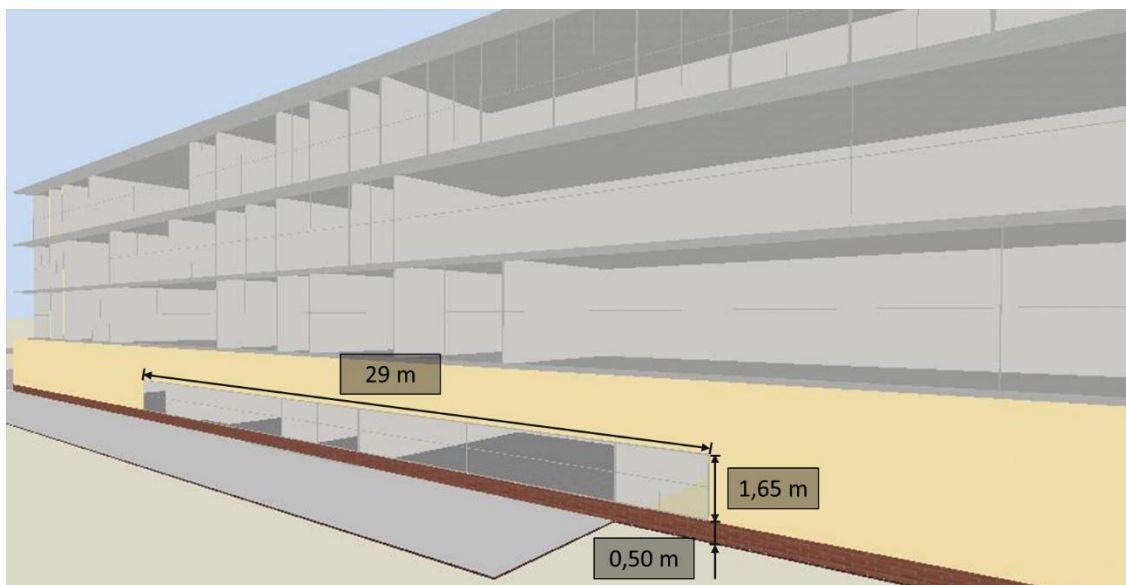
Dimensões do Vão Envidraçado da Fachada SE do Piso 0 do Longo Bloco com Gabinetes
